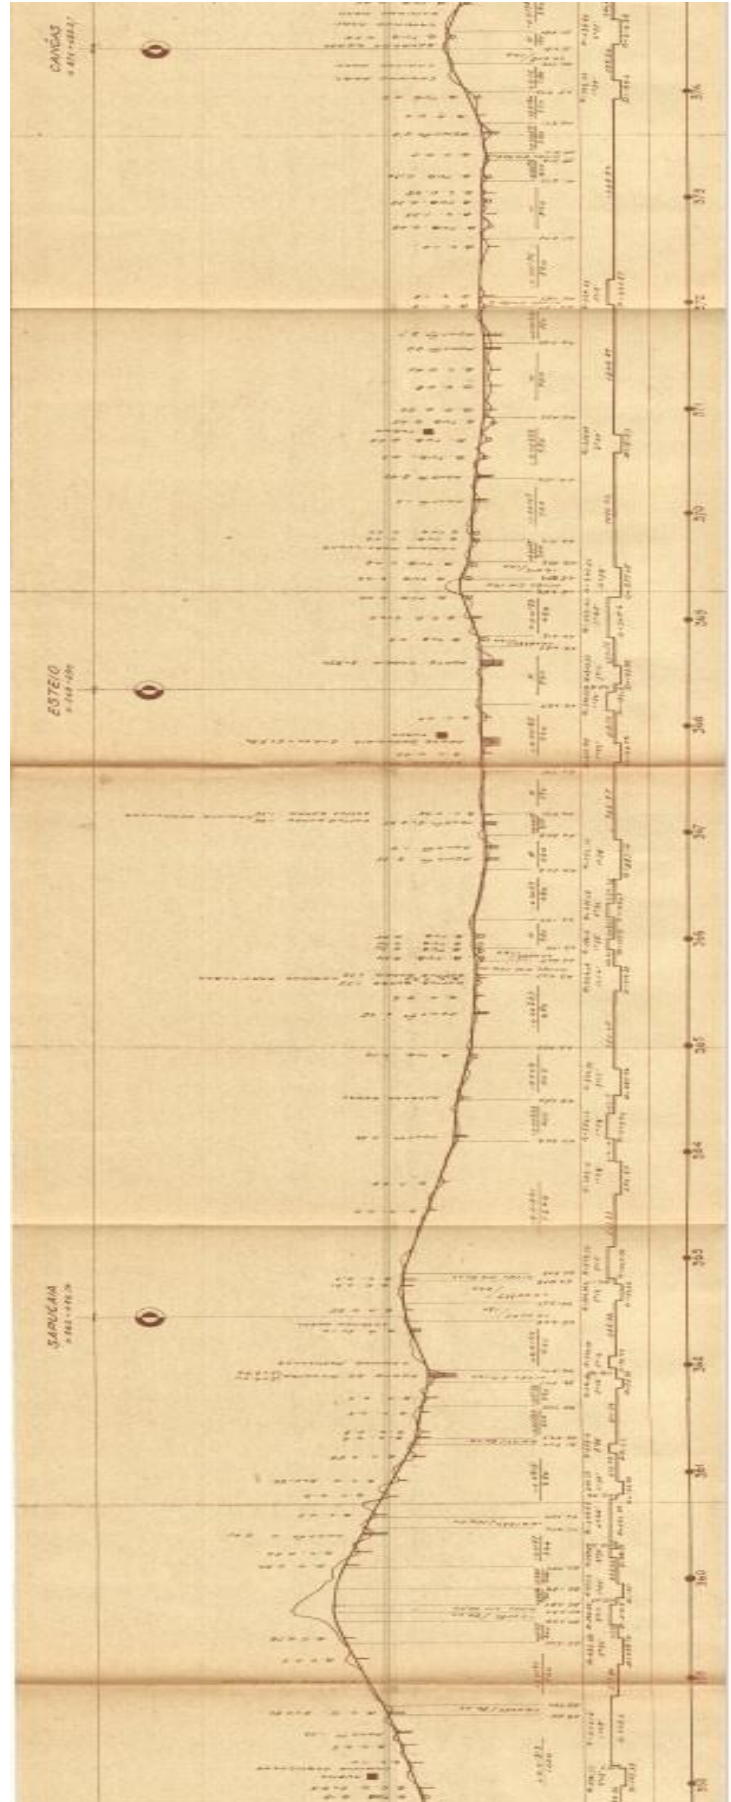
Fragmento da planta de Perfil Longitudinal do trecho Porto Alegre–São Leopoldo, RS (recorte do segmento Sapucaia-Esteio).
